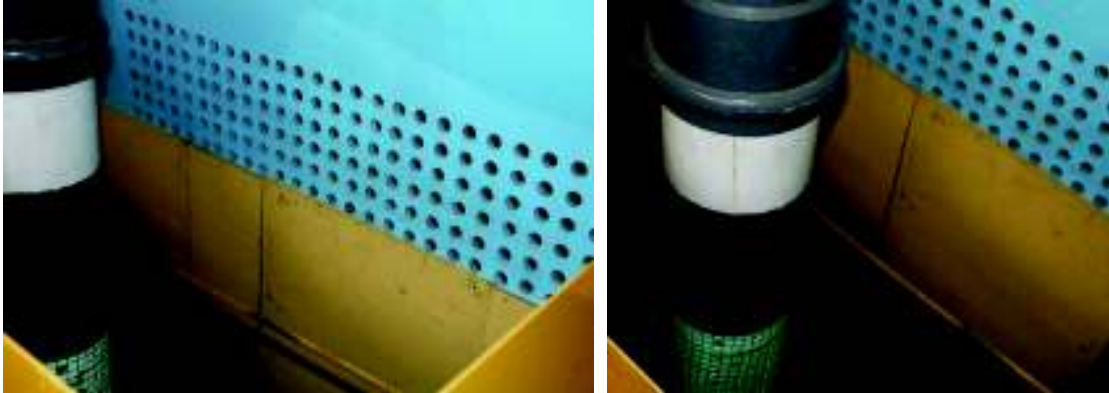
Colocación de la tubería a presión, junto con sus accesorios
